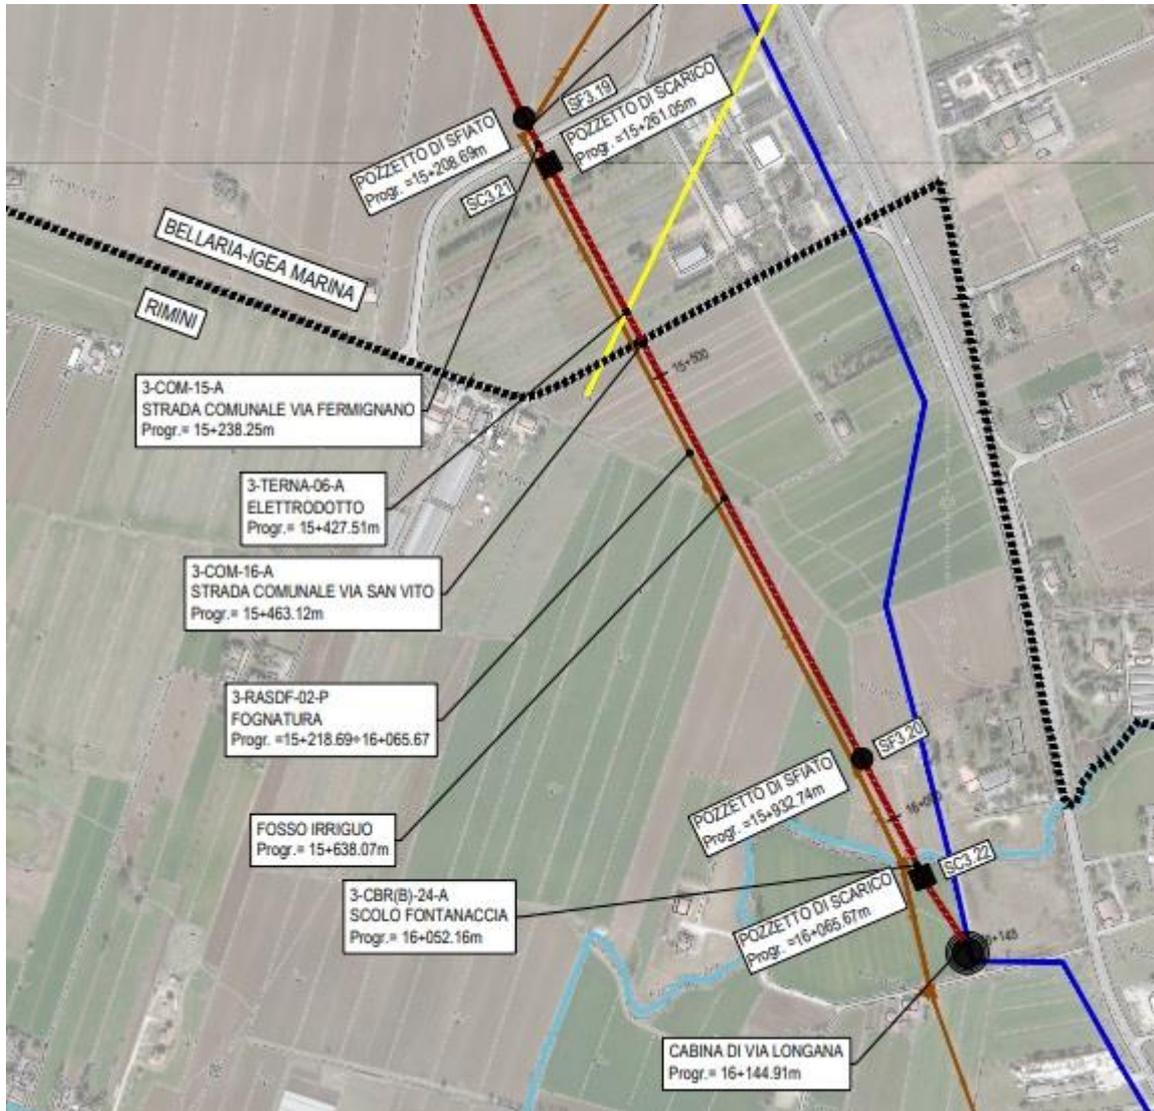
il tratto terminale del Lotto 3 con la connessione presso Torre Pedrera
